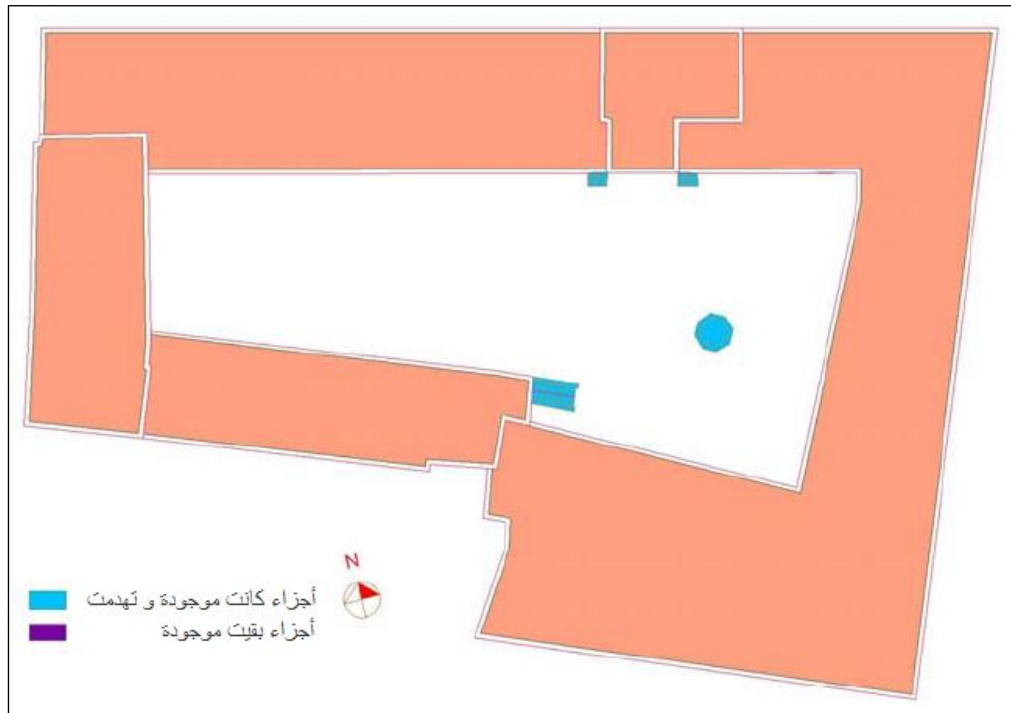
مخطط تصوري لما كان عليه الطابق الأول.¹³⁵
